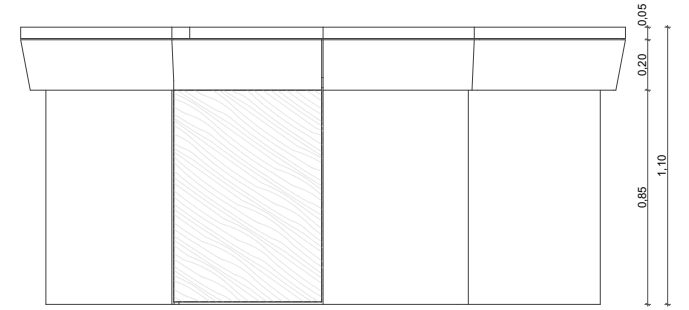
Detalle mesa con parrilla. Fuente: Elaboración Propia
